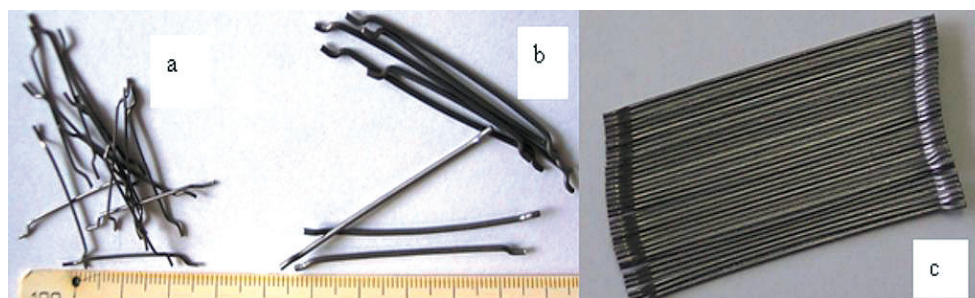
Fibras de aço soltas curtas (a) e longas (b) e longas coladas (c)
